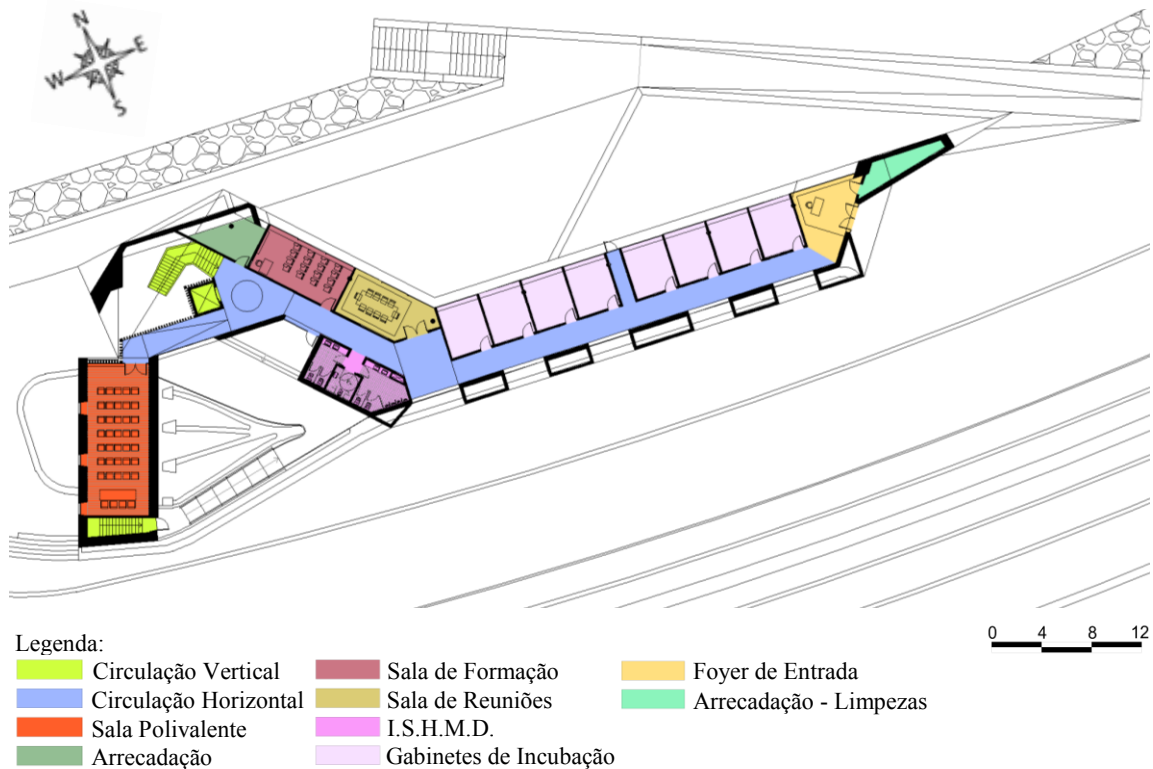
Planta do Piso 1 (Fonte: do autor)
